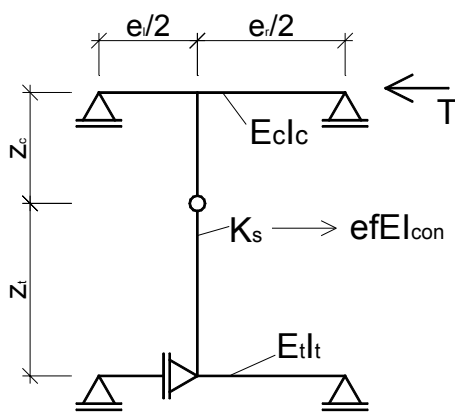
Stabwerksmodell zur Berechnung einer Holz-Beton-Verbundbrücke
